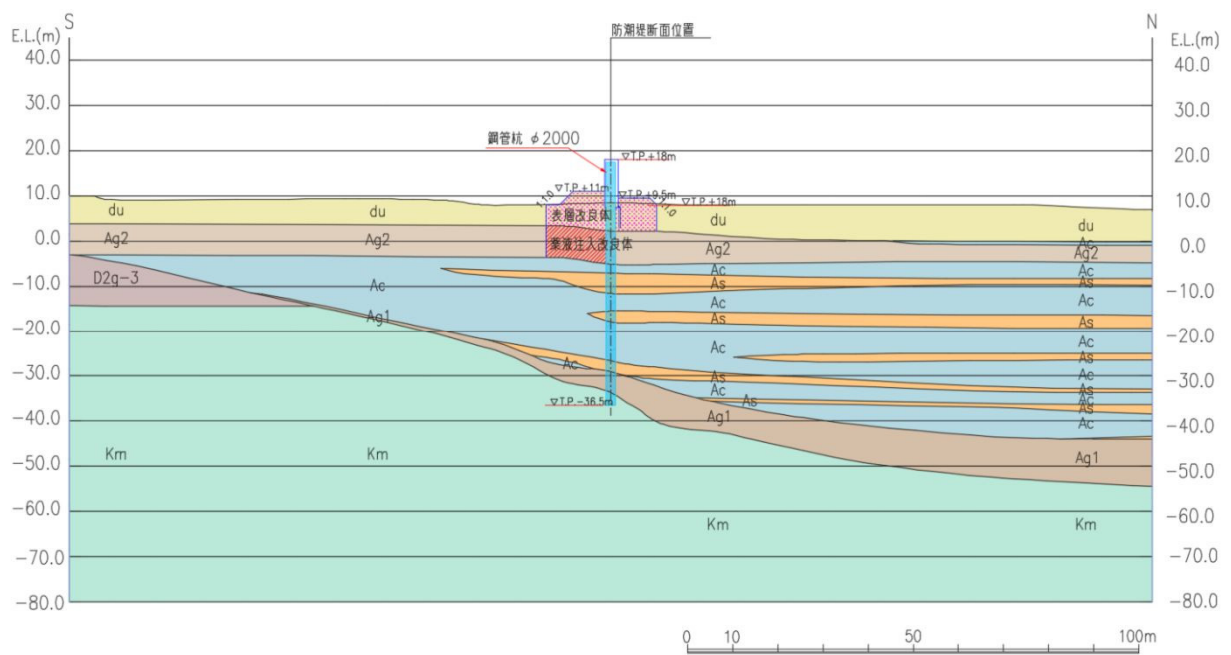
10. 5－29 (5) 鋼管杭鉄筋コンクリート防潮壁 断面図 (断面⑤)
